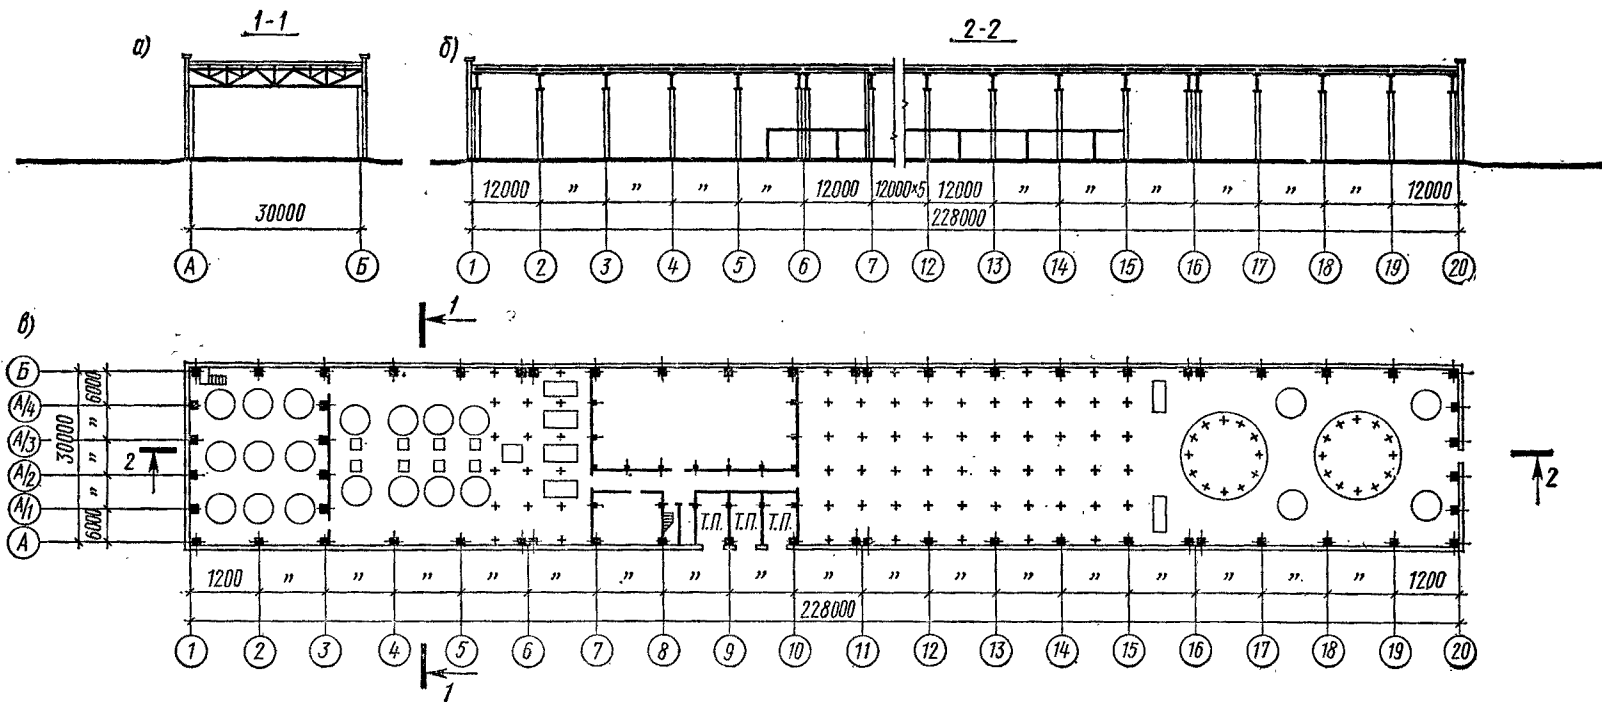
Корпус очистки водорода, хлоргаза и рассола:
